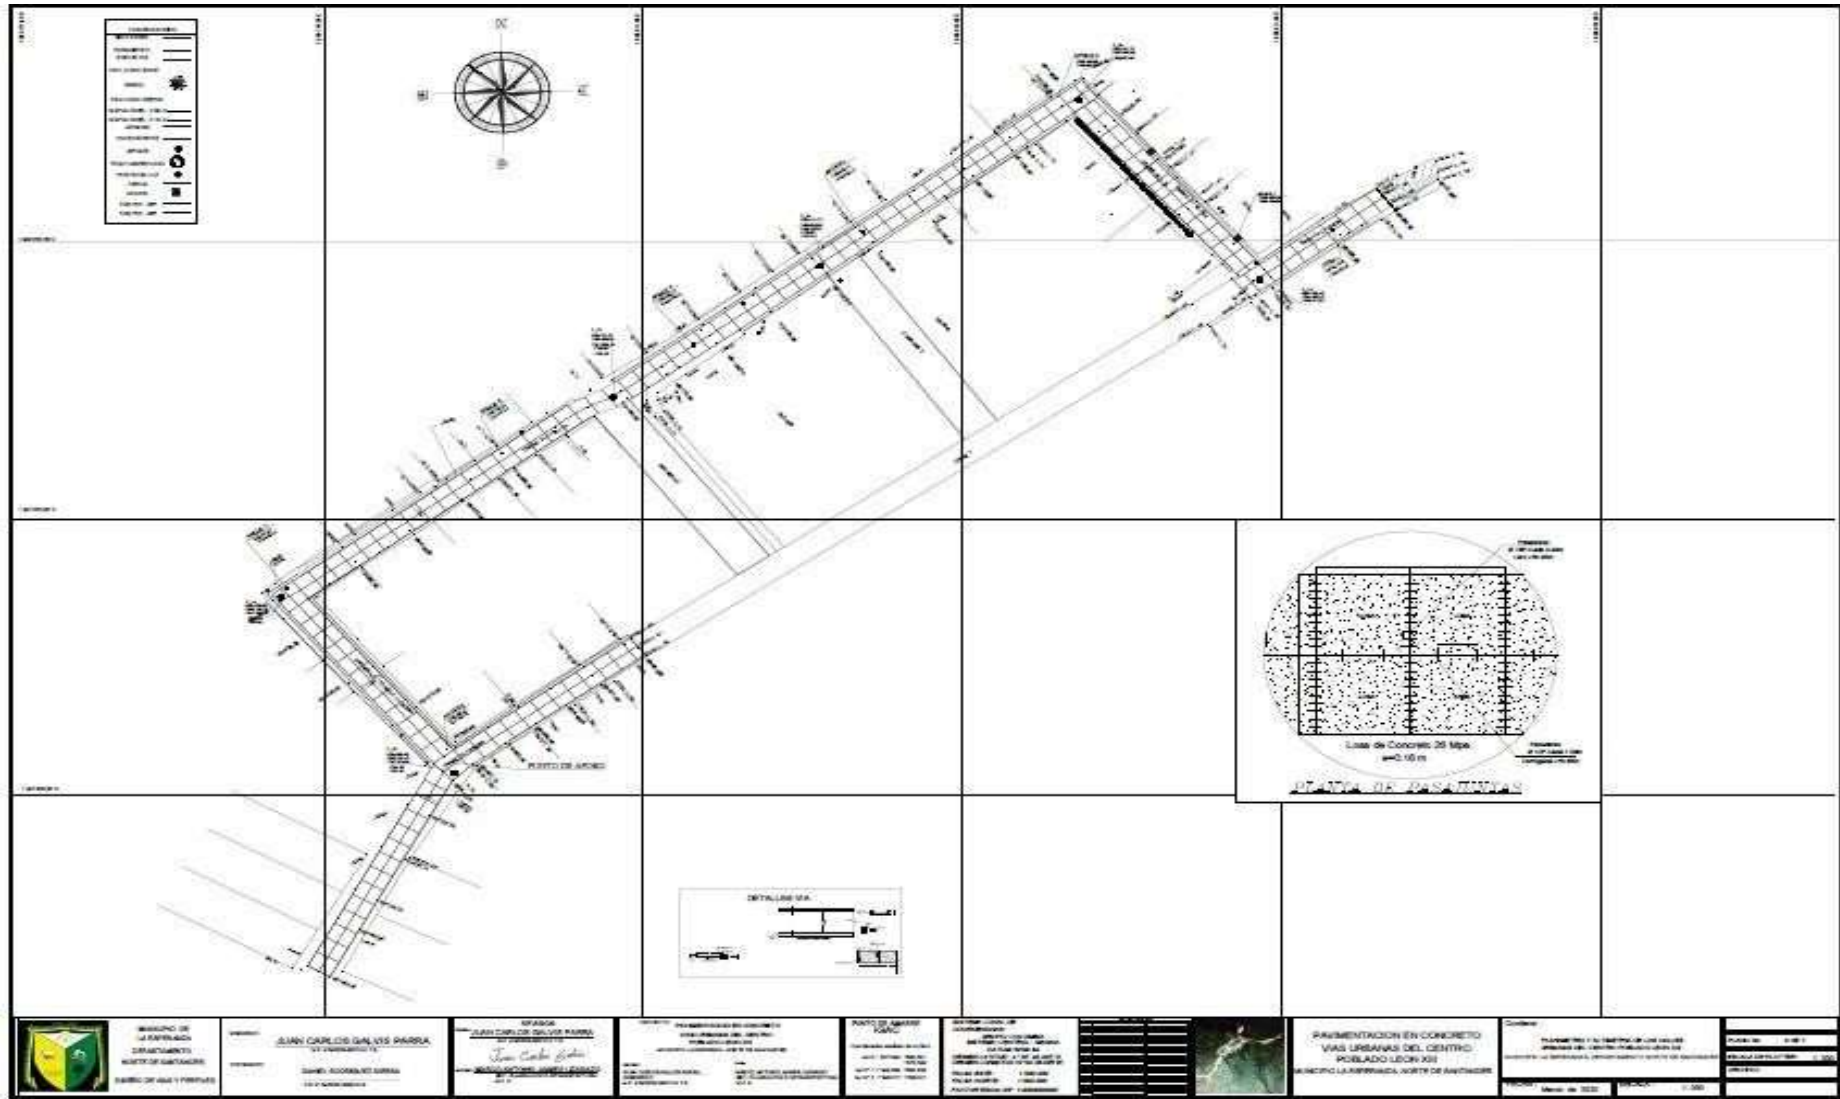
Vista en planta de topografía del área de construcción. Fuente: Secretaria de planeación de la alcaldía de la esperanza N.S.
